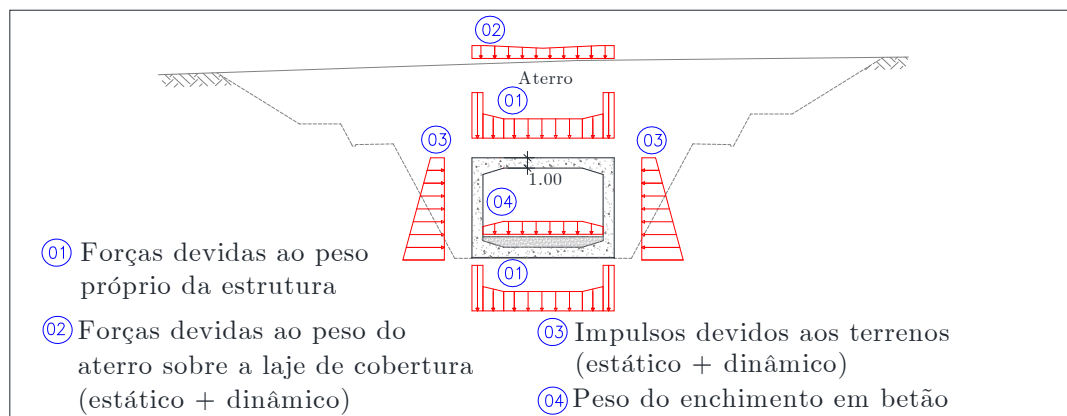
Caso de Carga 2 – Secção com laje de 1.00 situada entre taludes de escavação.
